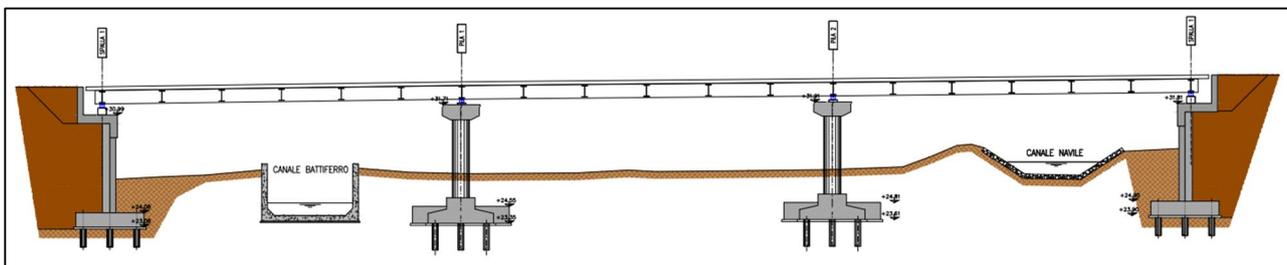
Sezione longitudinale sui canali Battiferro e Navile
